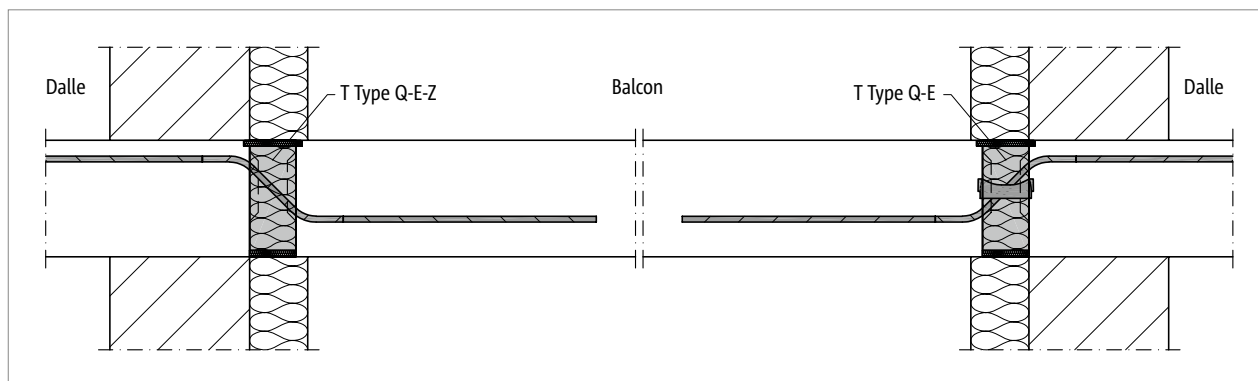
Schöck Isokorb® T Type Q-E-Z, Q-E : Application d'une dalle de béton armé à axe unique
